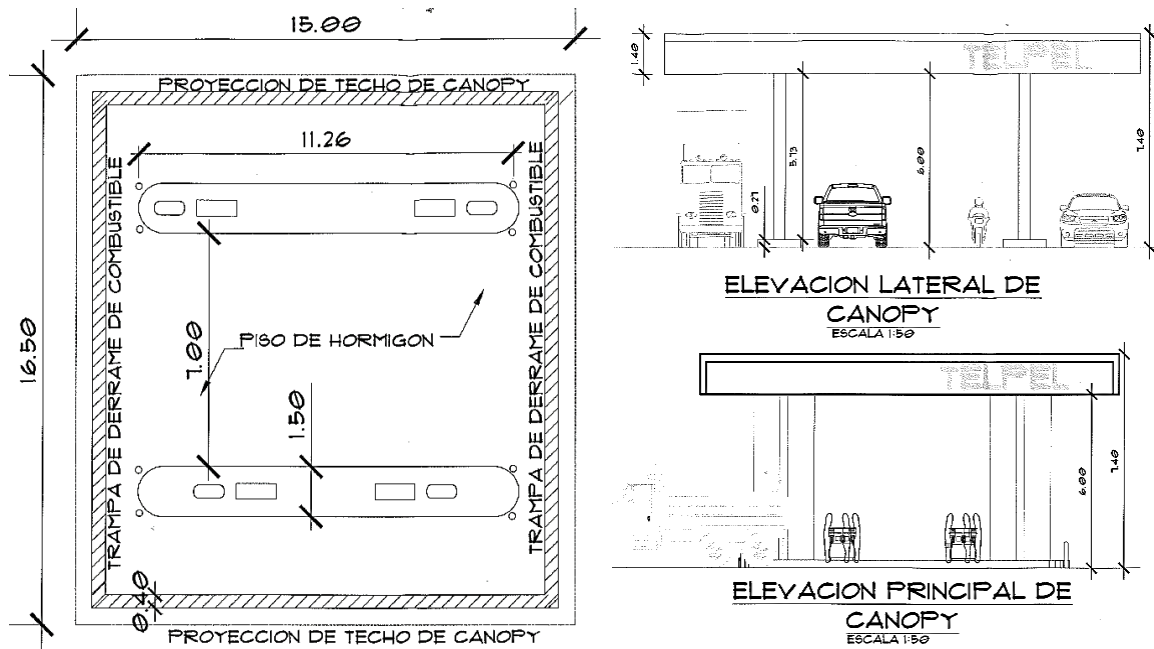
Planta arquitectónica de canopy y elevaciones
